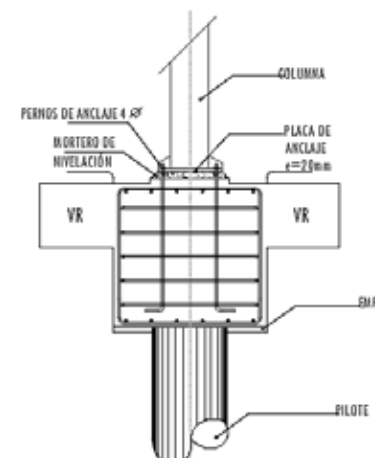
Detalle de fundación en corte. Fuente: Sosa (2020)
